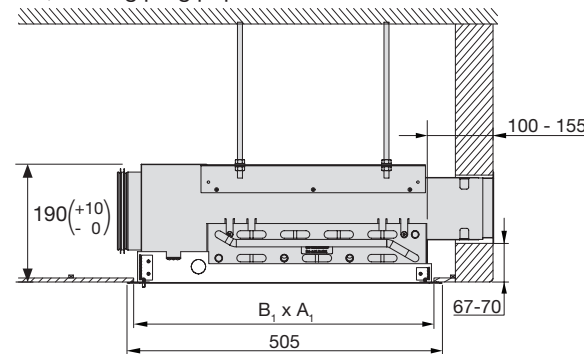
Tilluftsfrontplade -01/-21, dimensioner.
